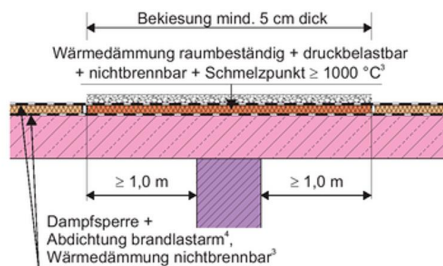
Prinzipdarstellung Bekiesung auf Dach
